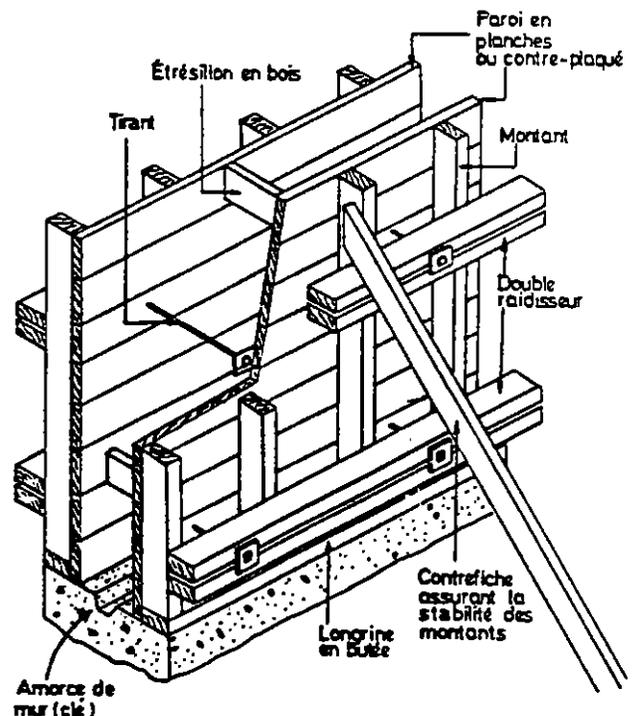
Coffrage conventionnel pour murs. (A. Lan)
